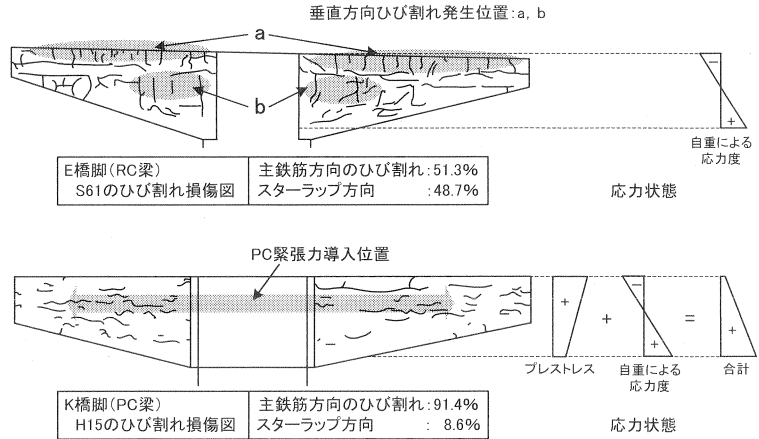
ひび割れの発生位置 (+ : 圧縮)
